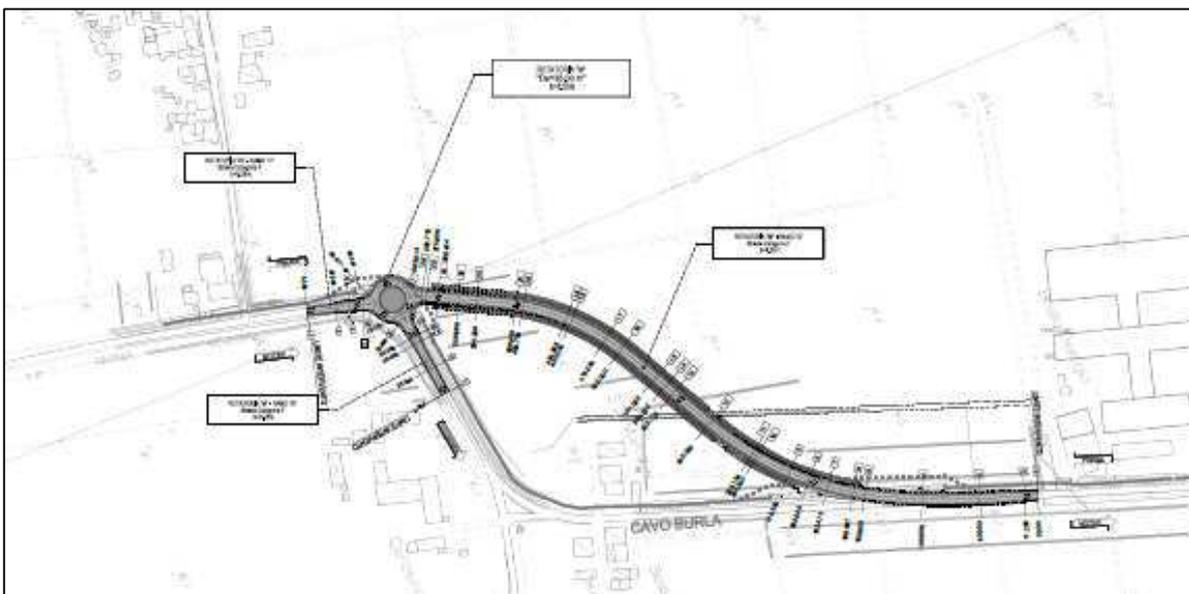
Planimetria di Progetto – Tratto A - Opera 1PR
